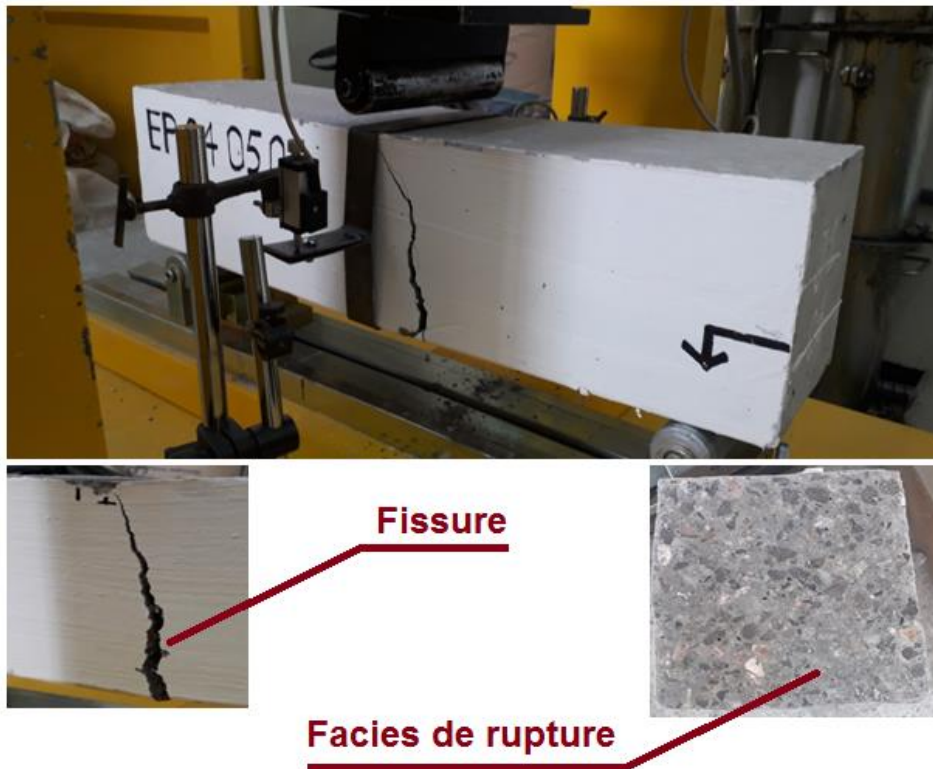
Mode de rupture des poutres en béton (Poutre témoin)
